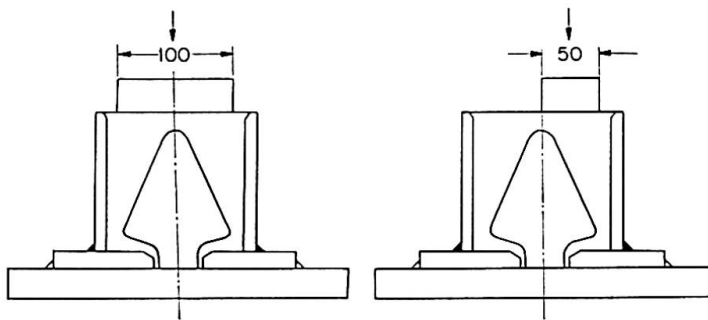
Vertikale Belastung mittig (Versuchsanordnung).
